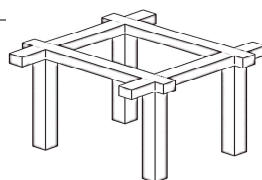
Premisa Tecnológica-constructiva 1. Fuente: Elaboración propia, 2018.
